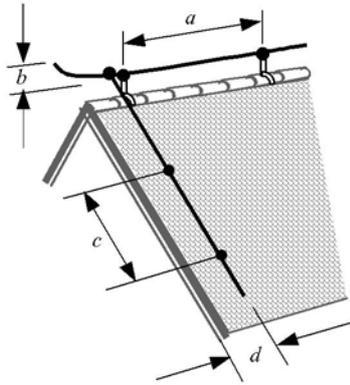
Anordnung einer Fangleitung auf dem First eines geneigten Daches und einer Dachableitung
